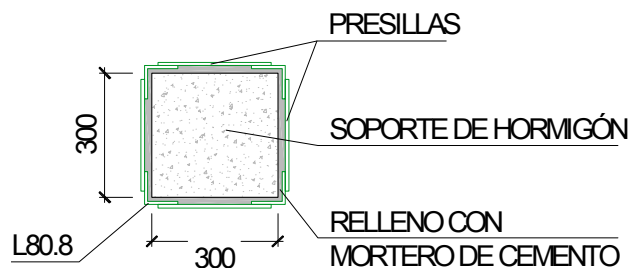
Sección transversal de una probeta reforzada (cotas en mm)
